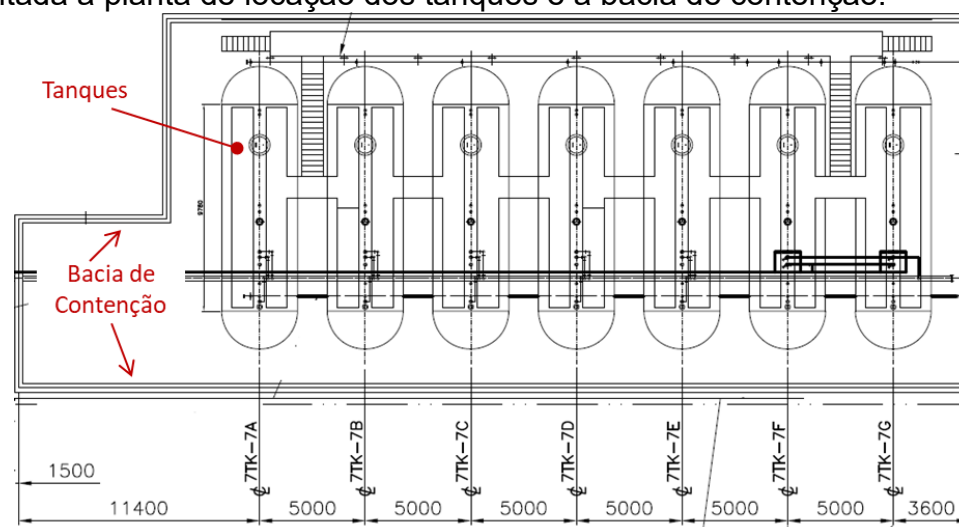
Planta de locação dos tanques e bacia de contenção.
